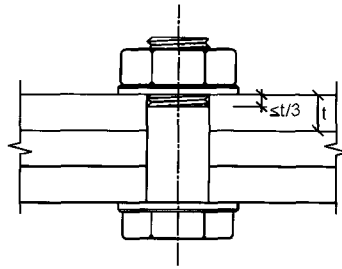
In ein Schraubenloch hineinragendes Gewinde von Passschrauben
